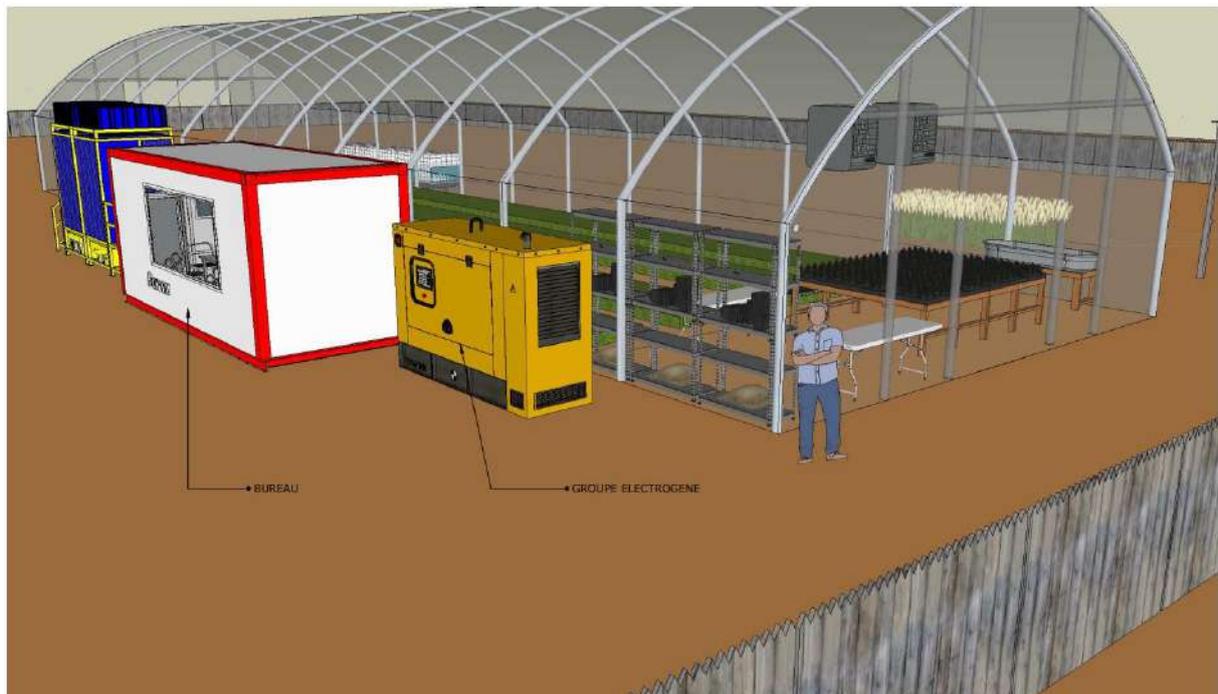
Exemples d'installations possibles sur le site de la pépinière.
